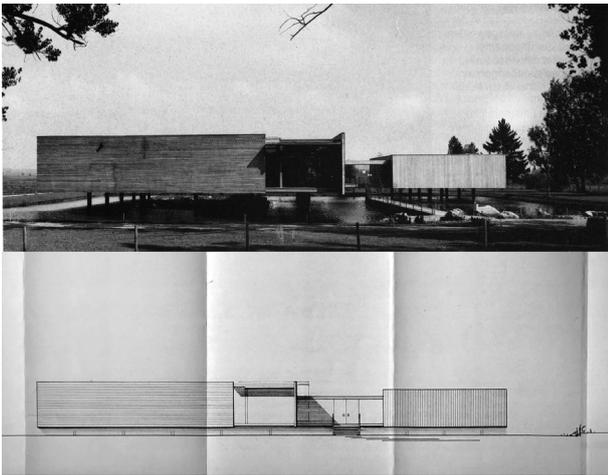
Manfred Lehbruck. Vista desde el acceso y alzado oeste del proyecto básico. Autor de la fotografía Sepp Mayer. Autor del plano: Manfred Lehbruck. En: DECHAU, W. In Ehren grau geworden. En: Deutsche Bauzeitung. Leinfelden Echterding: DB, enero 1990, n.124, pp. 98-101. ISSN. 0721-1902, p. 98.
